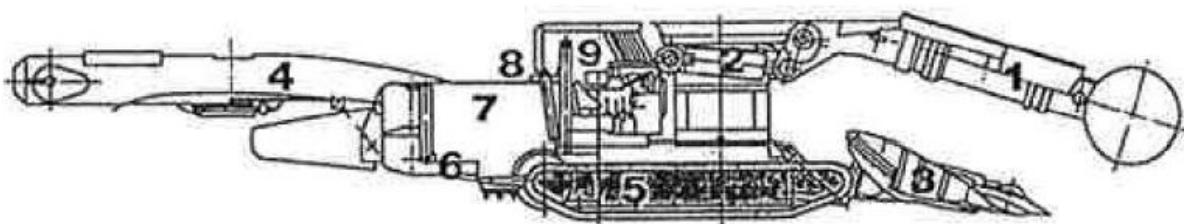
Aufbau einer Teilschnittmaschine (TSM) – (1) Schrägarm, (2) Schwenkwerk, (3) Ladeeinrichtung, (4) Kettenförderer, (5) Raupenfahrwerk, (6) Rahmen, (7) Elektrische Ausrüstung, (8) Hydraulische Ausrüstung, (9) Fahrerstand [55]
